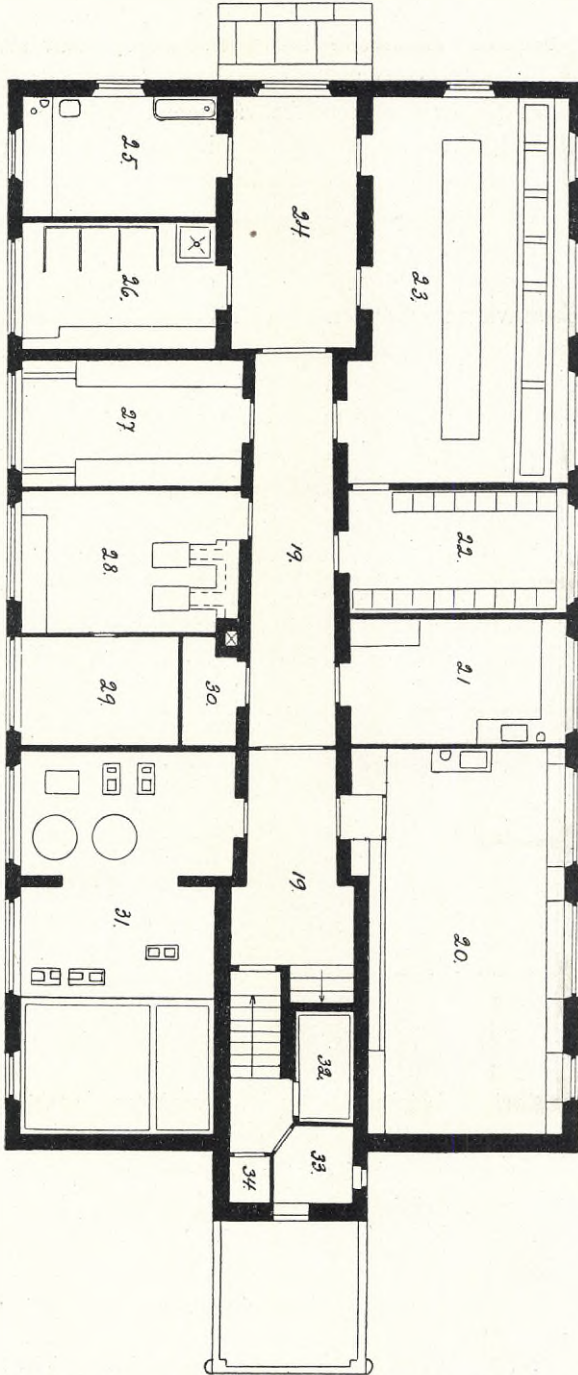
Plan av botten- och källarvåningen. (Plan of the combined Basement and Ground-floor.)
